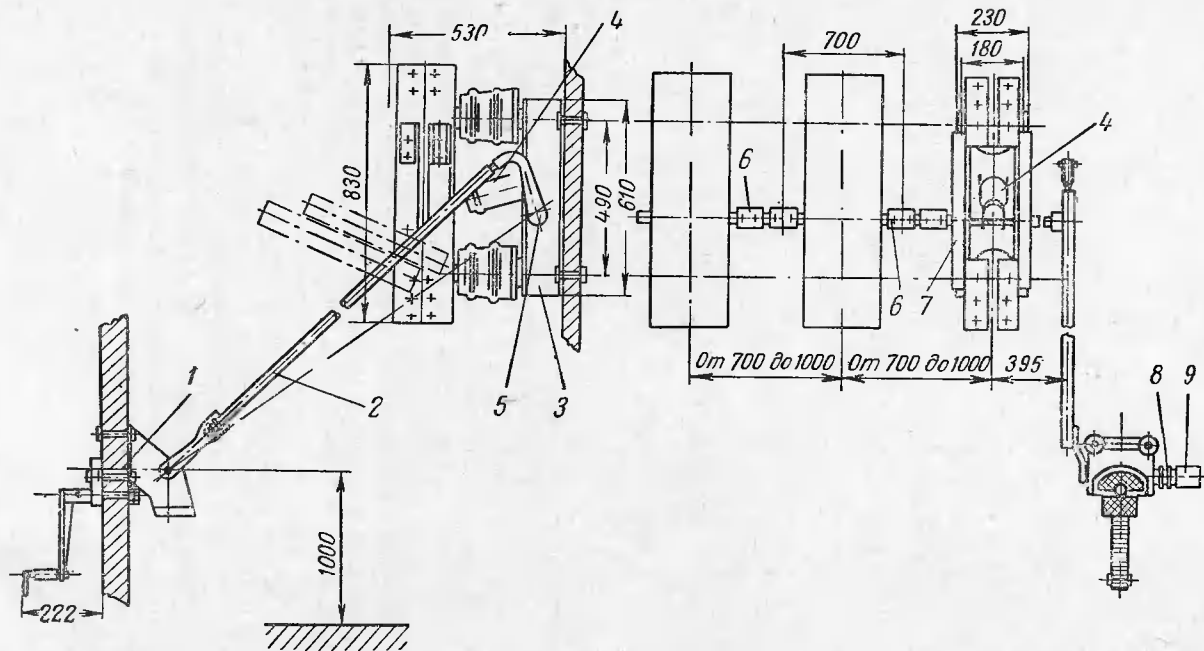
Установка трехполюсного разъединителя типа РВК с червячным приводом.
